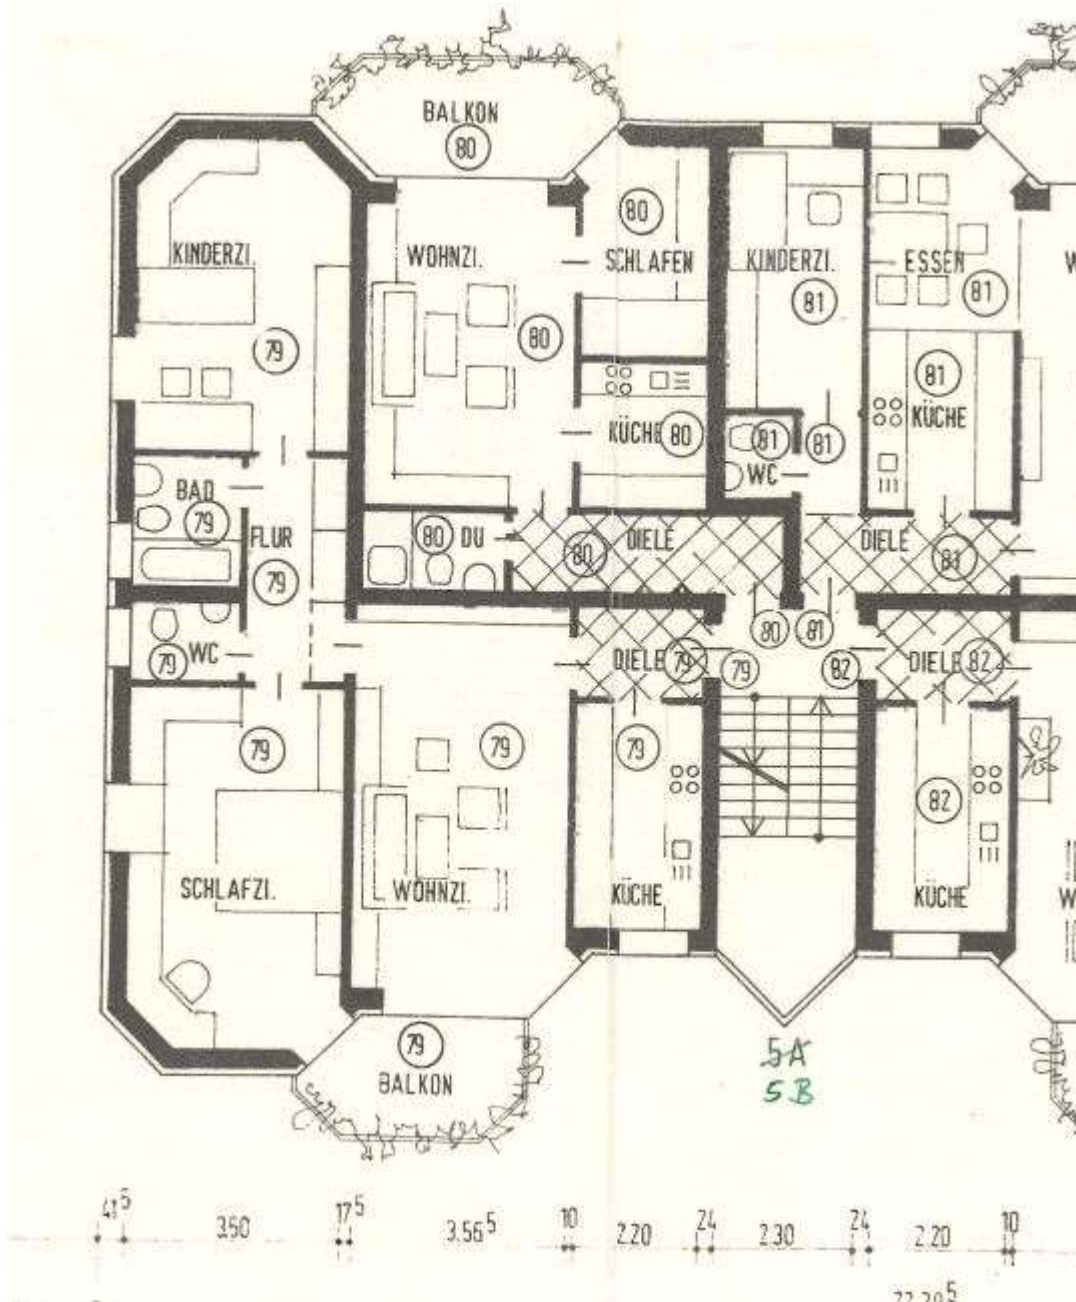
Grundriss SE Nr. 79 Quelle: Bauakte AG Duisburg
